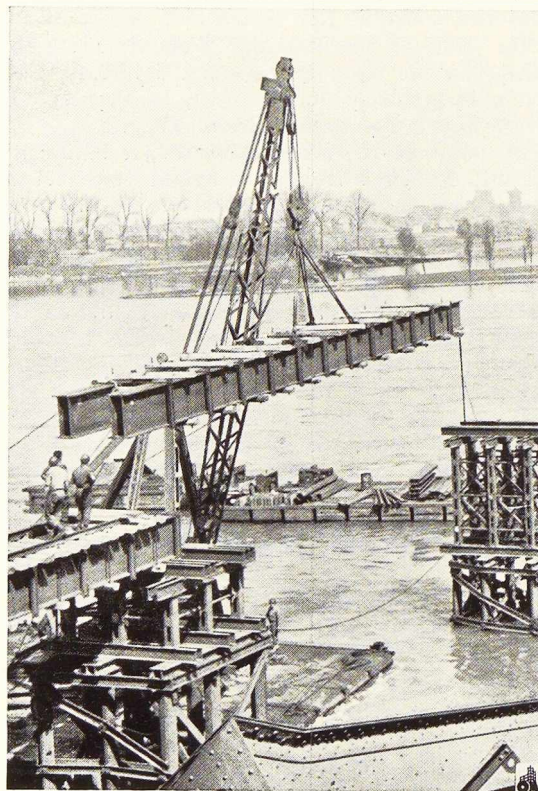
Mise en place d'une travée de 26 mètres de portée, constituée de 4 poutrelles à larges ailes.
